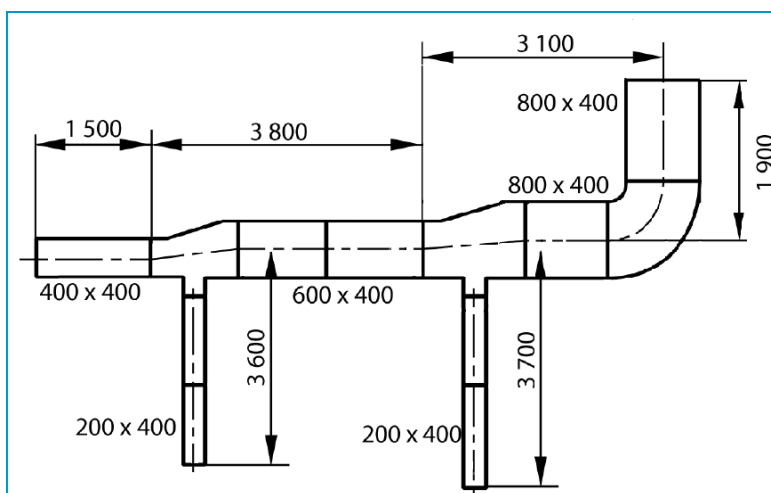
Exemple d'une installation type de réseau de conduits rectangulaires
